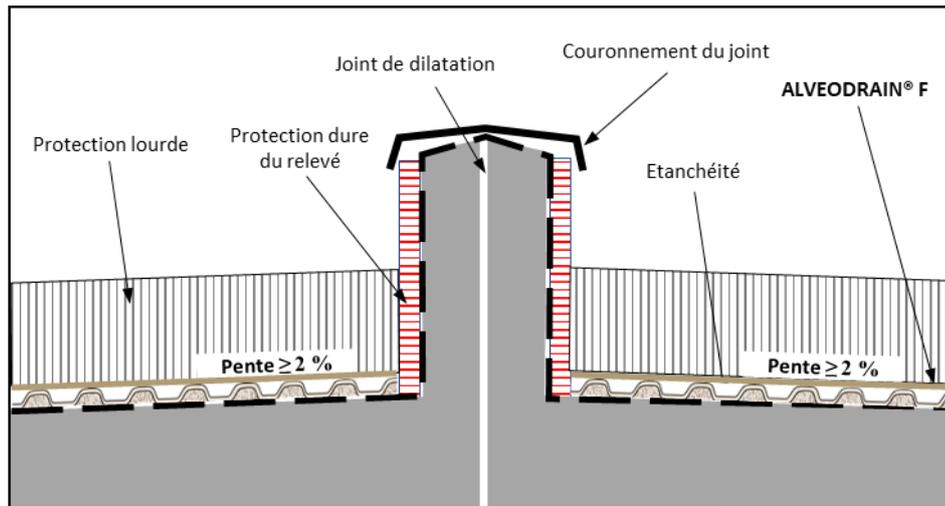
TRAITEMENT DE L'ALVEODRAIN® F AU NIVEAU DES JOINTS DE DILATATION SOUS PROTECTION LOURDE D'ETANCHEITE
